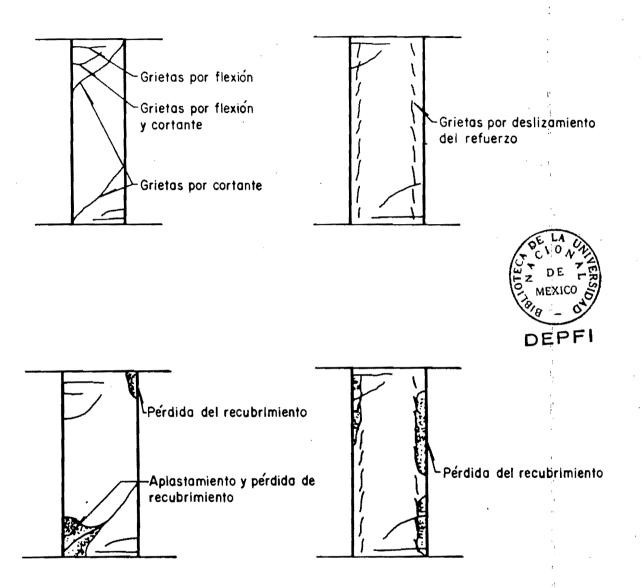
Ejemplos de patrones de agrietamiento de columnas de concreto reforzado
